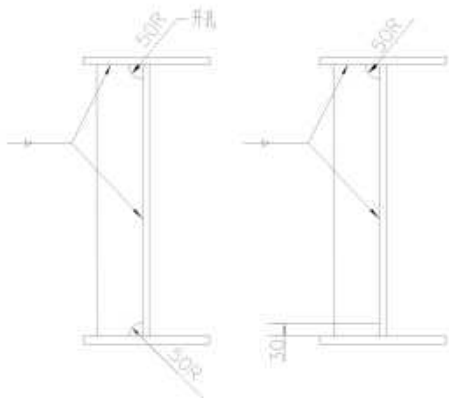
腹板加劲肋与顶底板连接排水孔构造细节（单位：mm）
